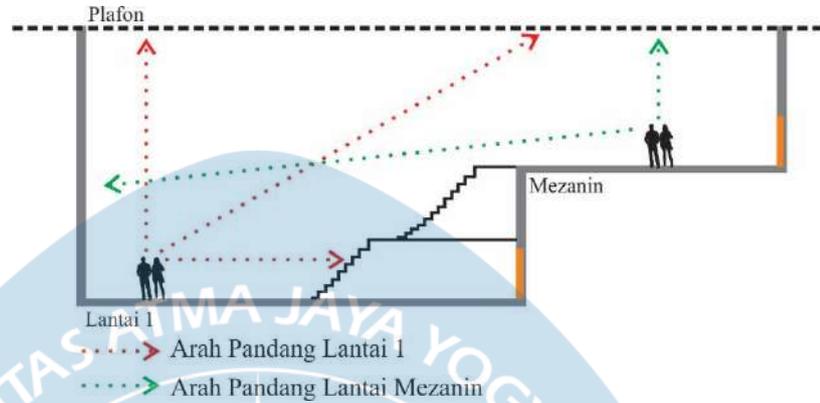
6 Konsep Layout Ruang pameran beserta alur sirkulasi pengunjung
